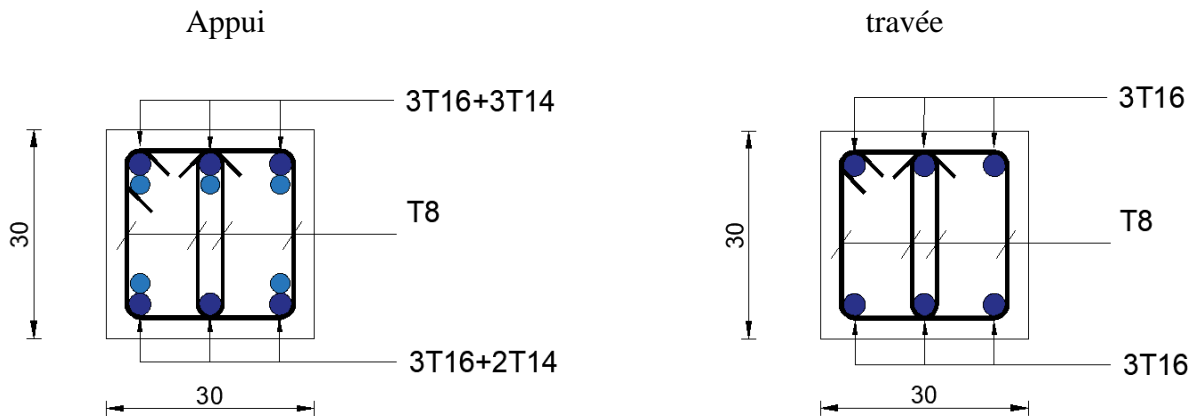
schéma de ferrailages des poutres non porteuse (9^{ème} étage)
